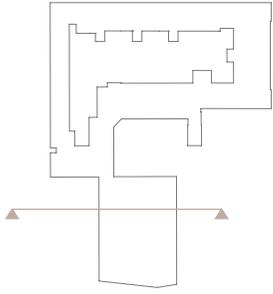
Lageplan-Freiraumgestaltung 4-5
